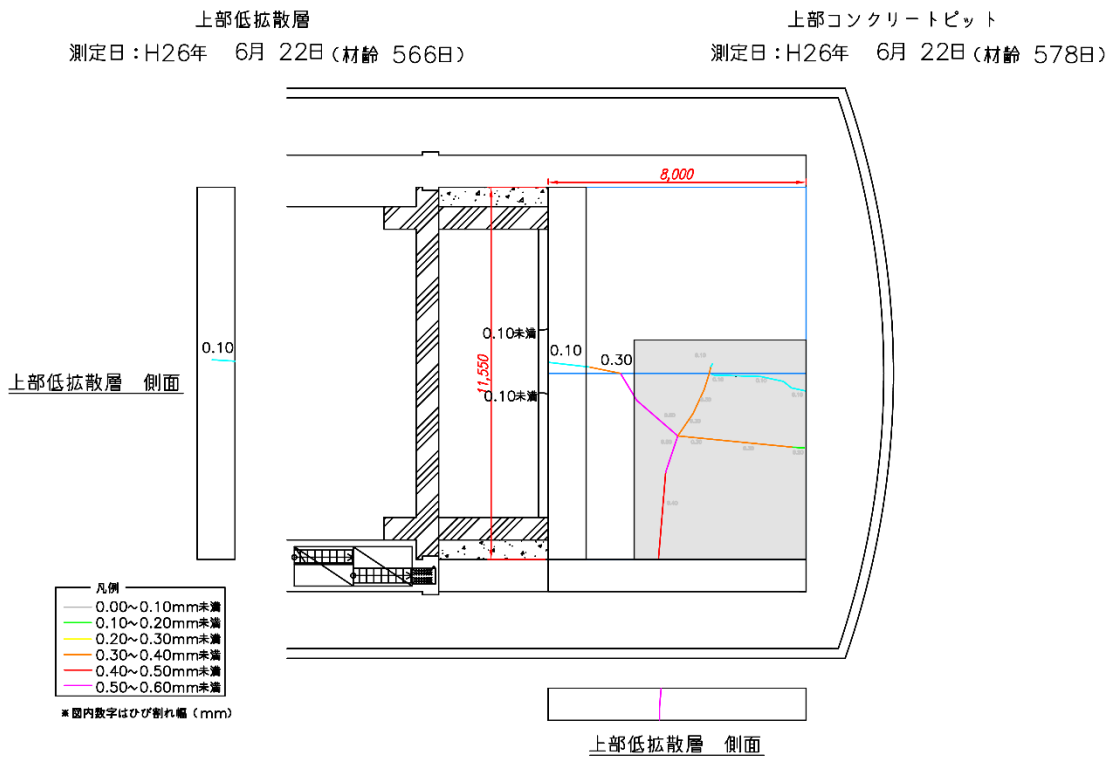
上部コンクリートピットおよび上部低拡散層のひび割れ履歴図（その2）
